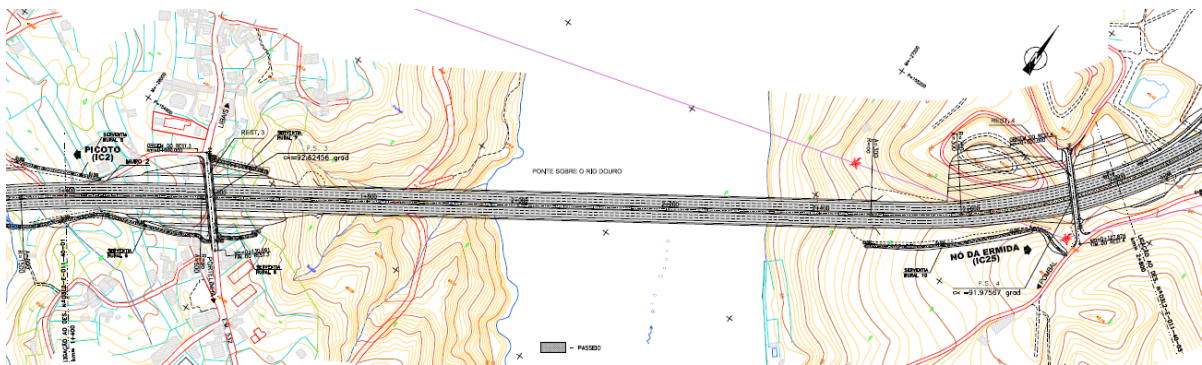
Vista em planta da Ponte sobre o Rio Douro em fase de projeto.
